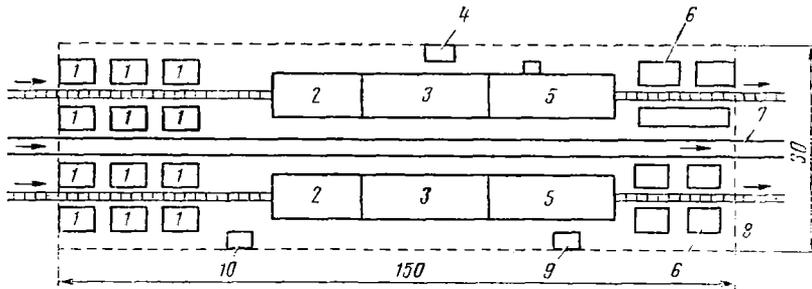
План строительного полигона для поточного изготовления деревянных конструкций
